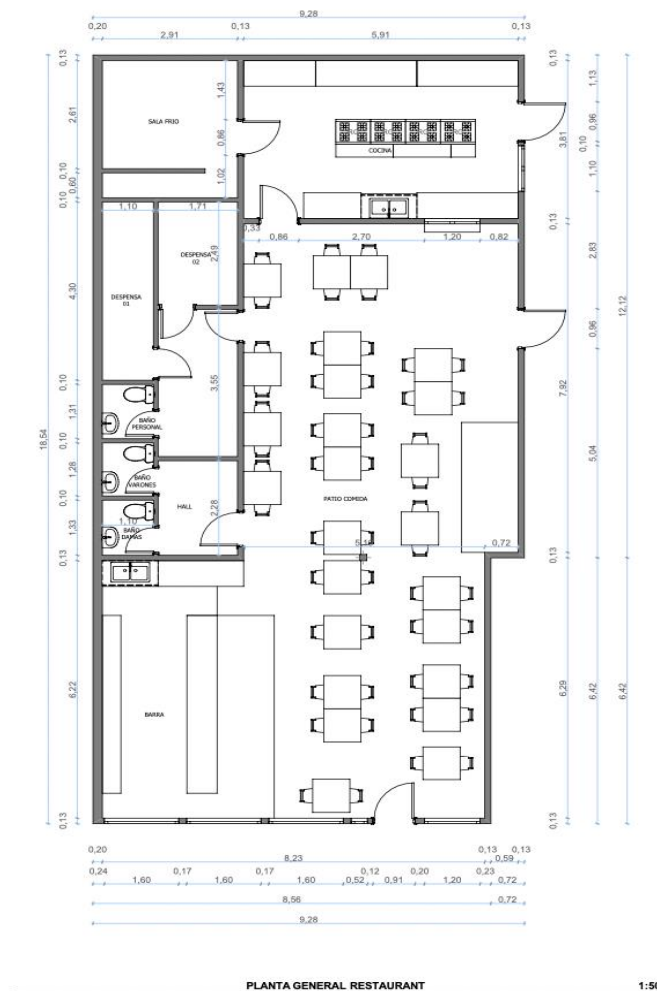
IMAGEN: PLANIMETRÍA CORRESPONDIENTE A SECTOR INTERNO DEL LOCAL
